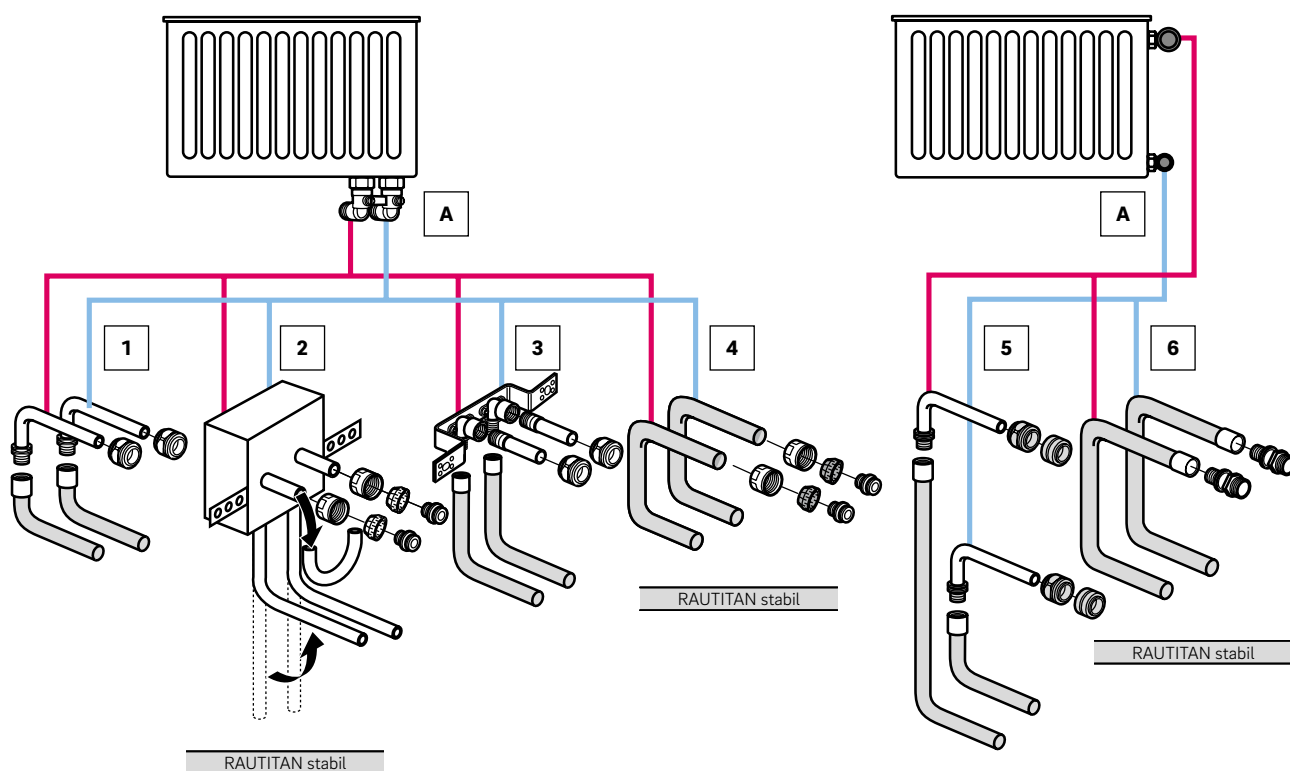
Panoramica del collegamento degli elementi riscaldanti dalla parete
